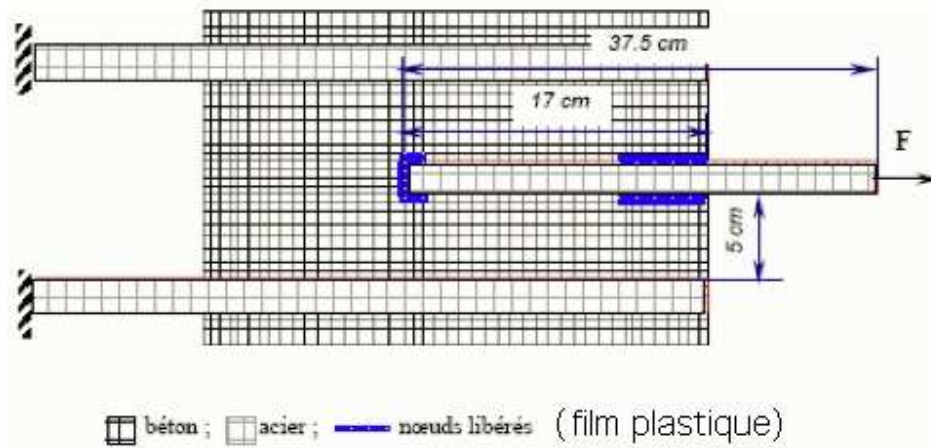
Plan de l'éprouvette de l'essai d'arrachement sur barres corrodées.
